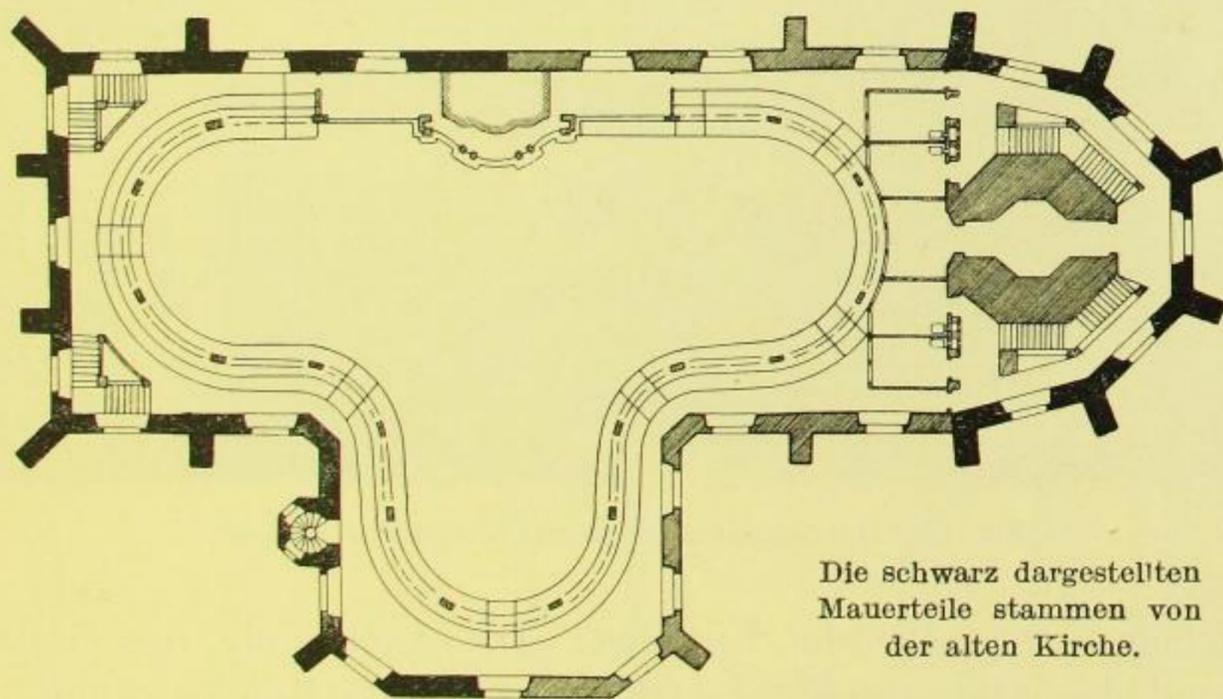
Marienkirche, Planung zum Grundriß in Höhe der Logen.
